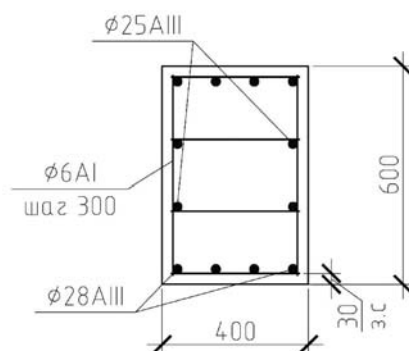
Схема расположения рабочей арматуры в железобетонных опорах сечением 400х600 мм
